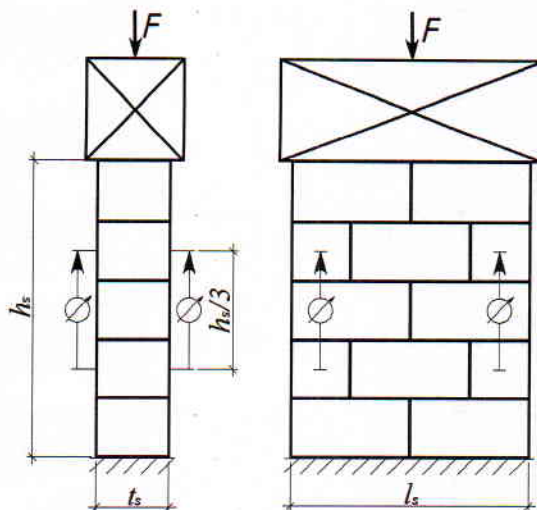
схема испытаний образцов кладок на сжатие
